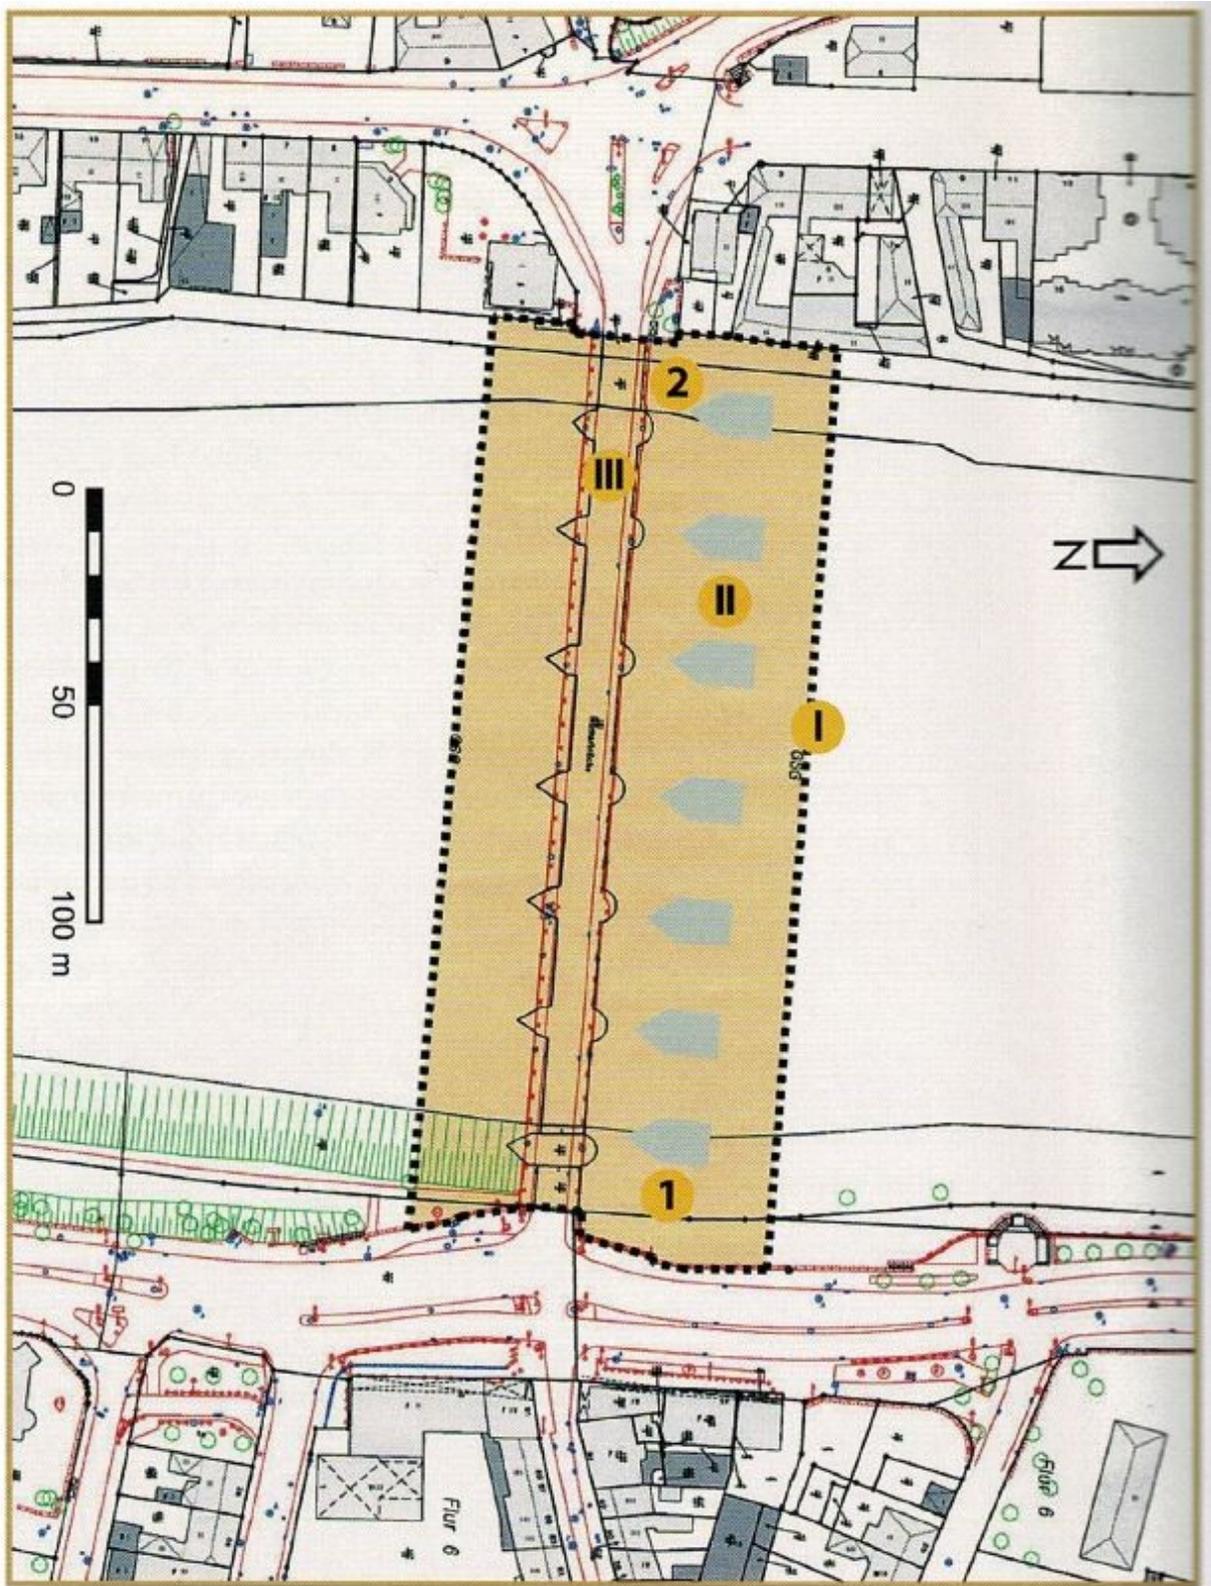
Grundriss der drei Brücken im Straßenbild Triers (Goethert 2010)
